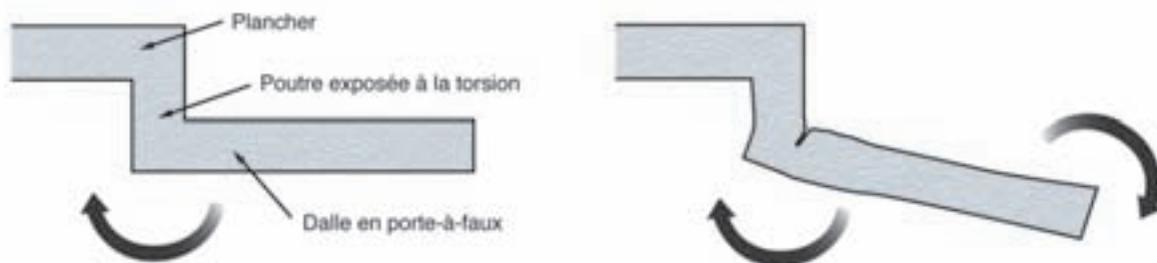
A éviter : poutre porteuse sollicitée en torsion par la dalle du balcon
